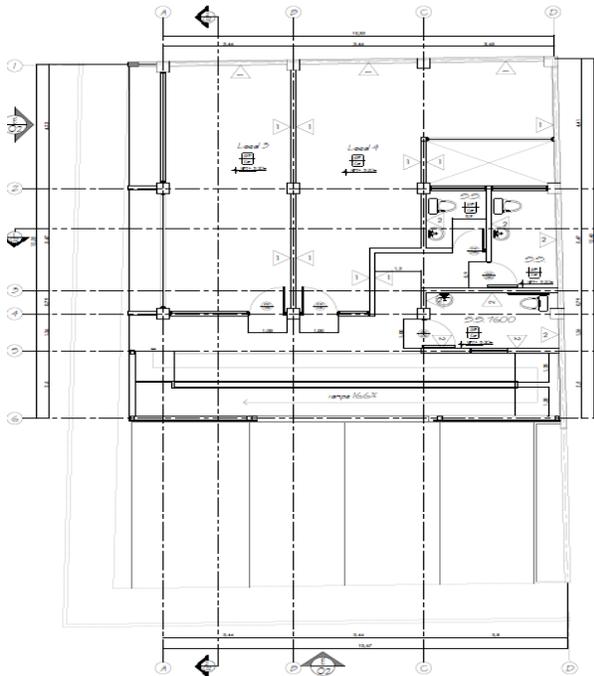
Planta de Distribución Arquitectónica segundo nivel UCADEA
